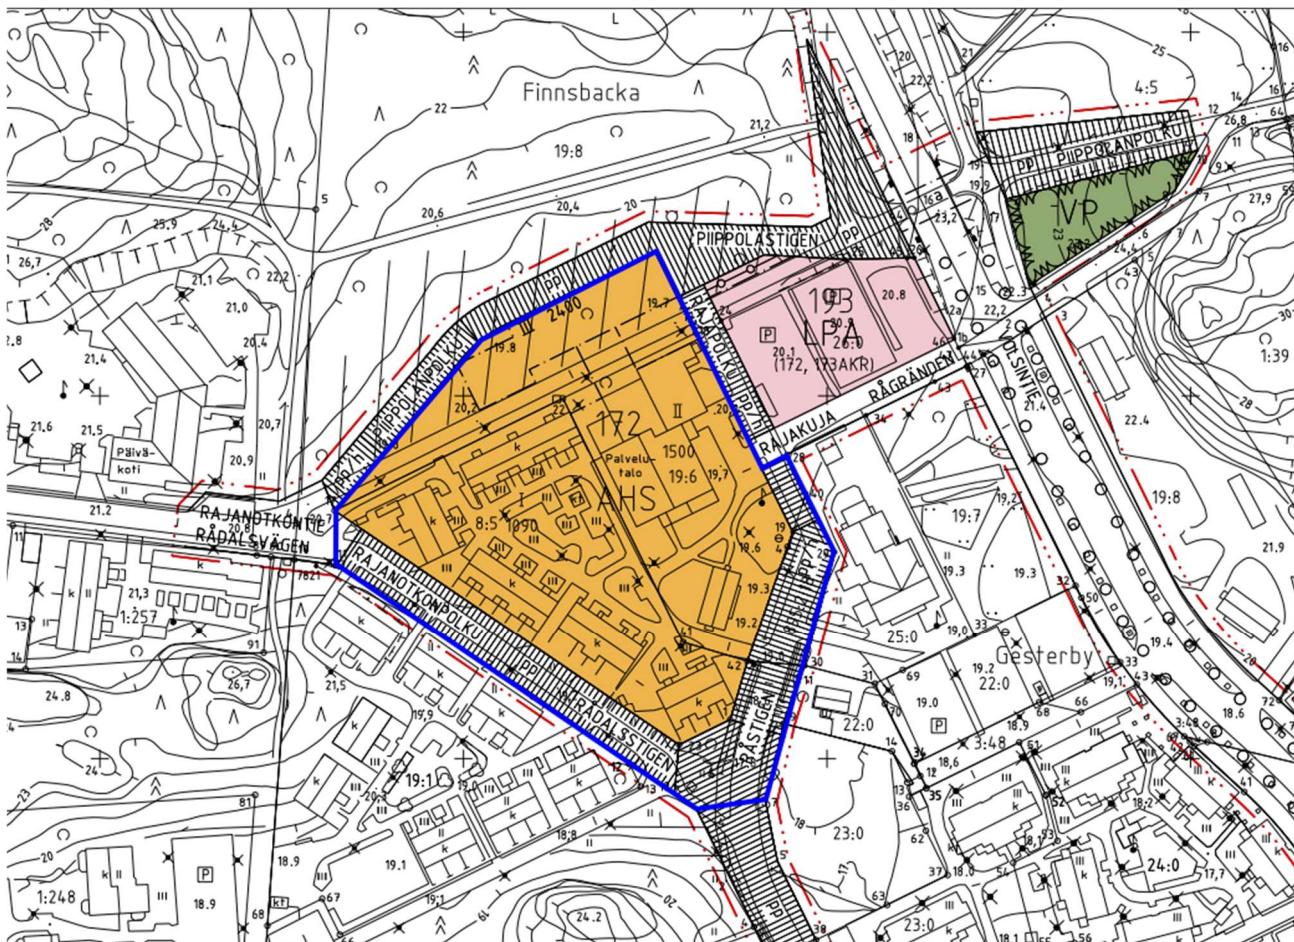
, Utdrag ur den gällande detaljplanen. Avgränsning av planeringsområdet i blått.
